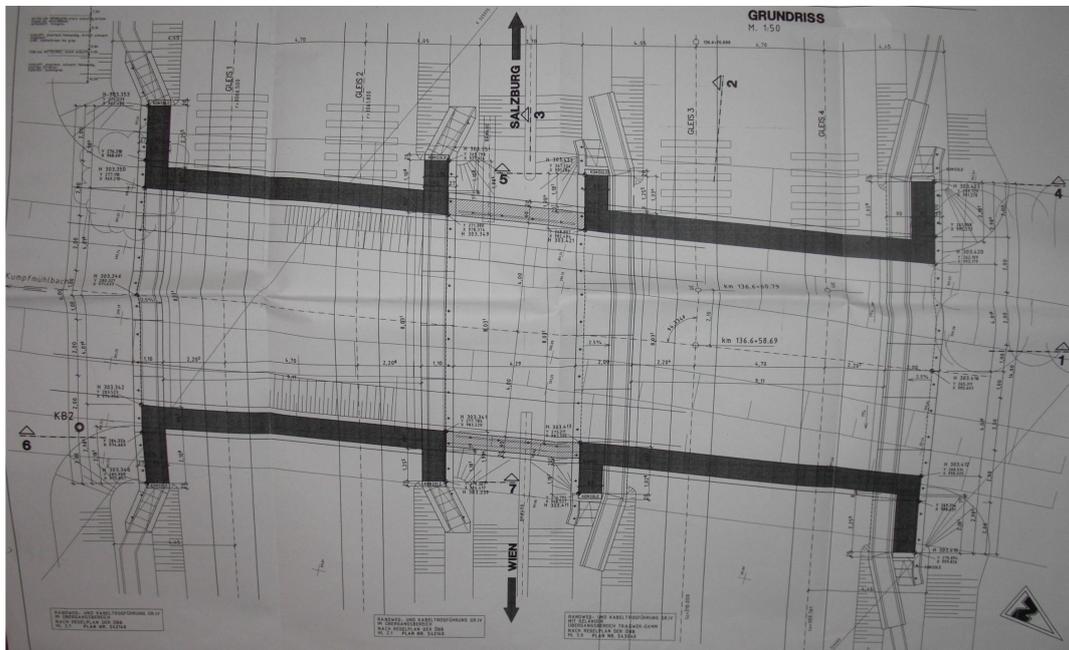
Grundriss – Rahmenbrücke
